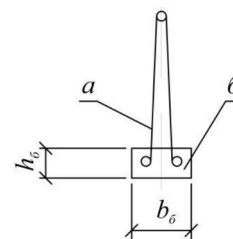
Легкие железобетонные балки с пространственным арматурным каркасом (а) и железобетонным основанием (б) (элемент несъемной опалубки)
